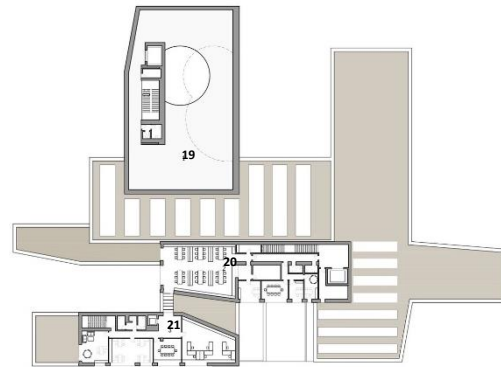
Planta de primer nivel arquitectónica del conjunto MUSEO IBERO. Santibañez, D. (12 de septiembre de 2020). ArchDaily.
